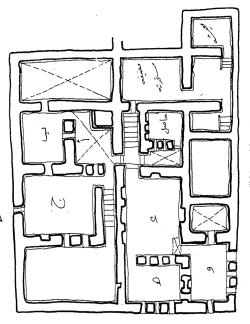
منزل القاضي عمر الدور الأول - مسقط أفقى
